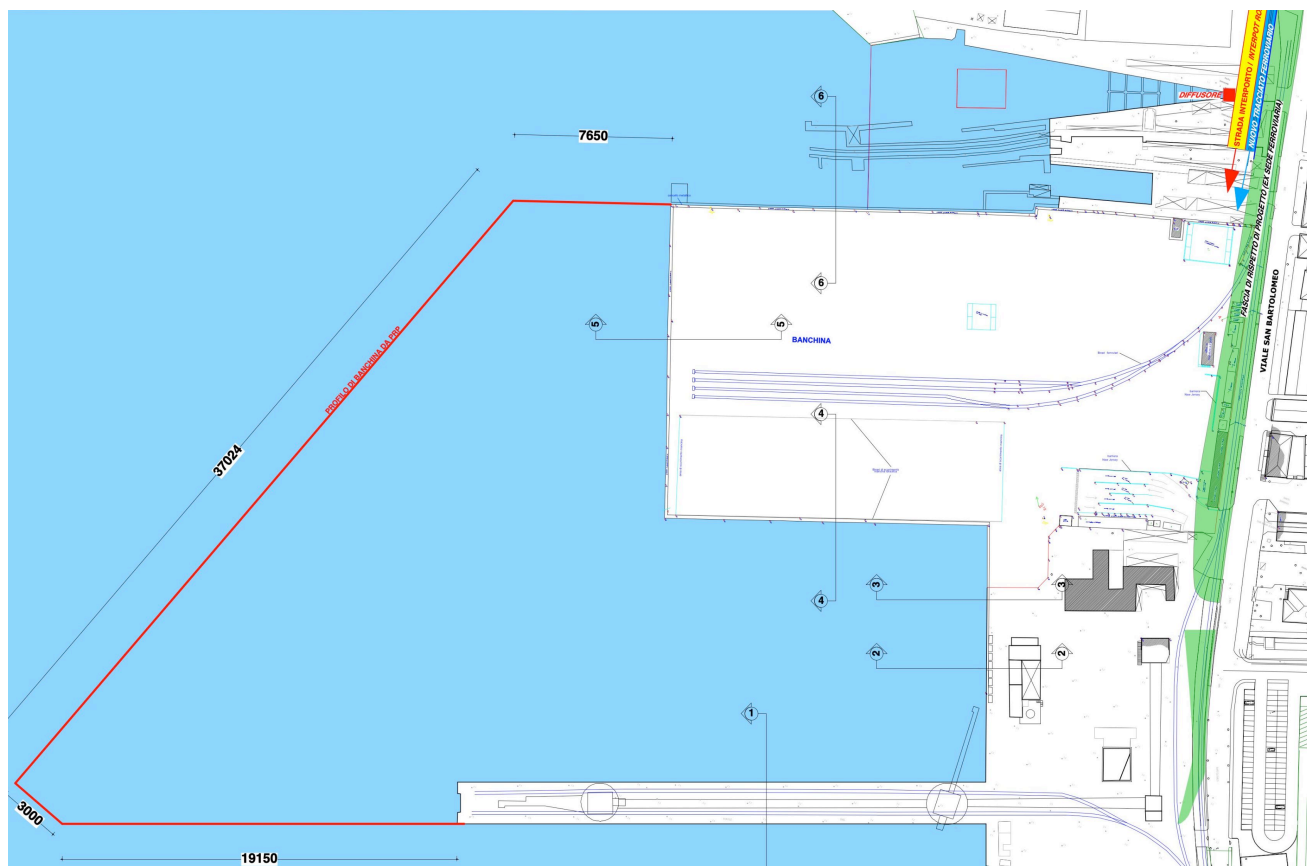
esemplificazione dei vincoli progettuali: profilo di banchina, fascia di rispetto, nuovo accesso
